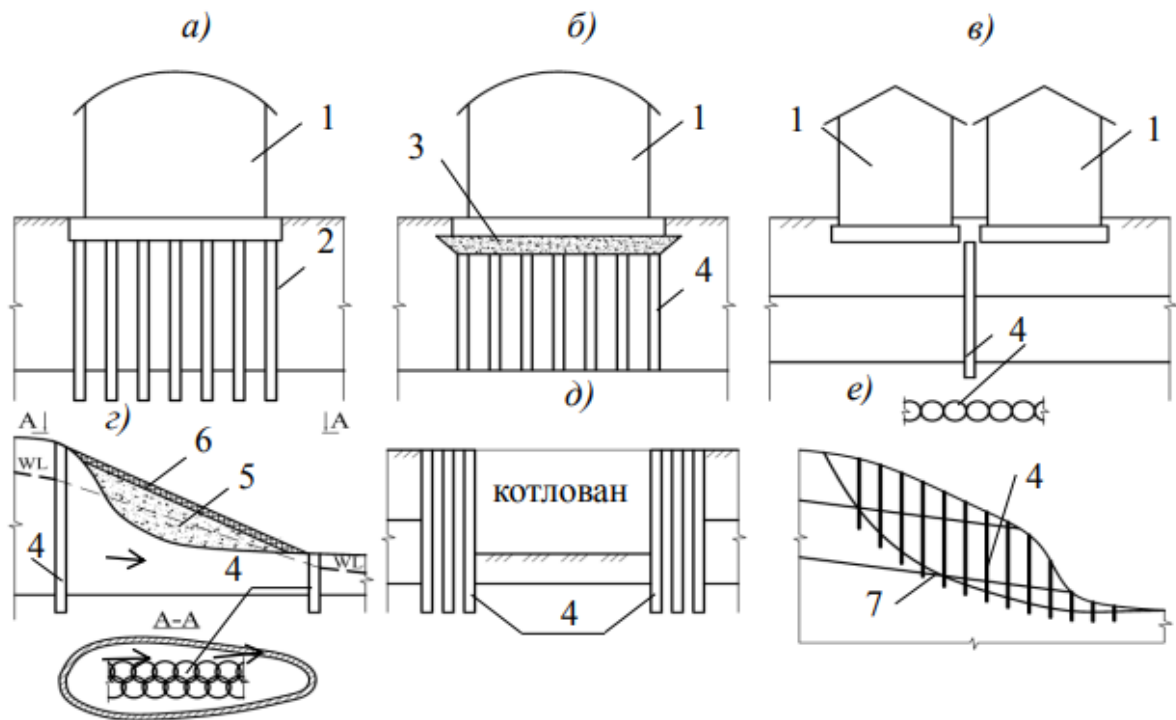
Варіанти використання вертикальних ґрунтоцементних елементів, які виготовлені бурозмішувальним способом; а – ґрунтоцементні палі; б – закріплення слабких ґрунтів основи; в – захисний екран для зниження впливу новобудов для існуючі будівлі; г – протифільтраційна завіса; д – укріплення бортів глибоких котлованів; е – закріплення зсувонебезпечних схилів: 1 – будівля; 2 – ґрунтоцементні палі; 3 – розподільча подушка зі щебеню; 4 – ґрунтоцементні елементи; 5 – токсичні відходи; 6 – захисний шар ґрунту; 7 – поверхня ковзання
